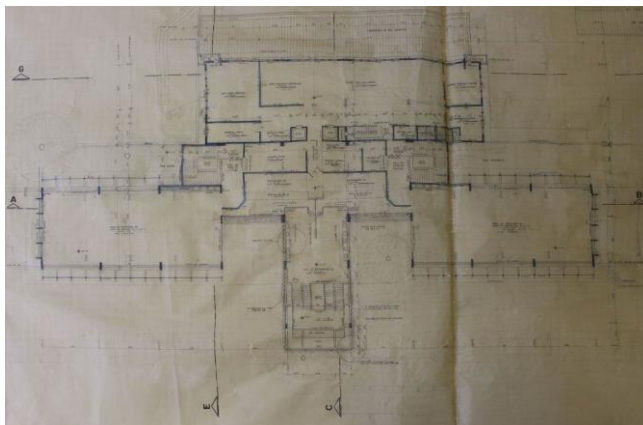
Planta Segundo Pavimento RU, 1977. Fonte: Acervo SUMAI.
